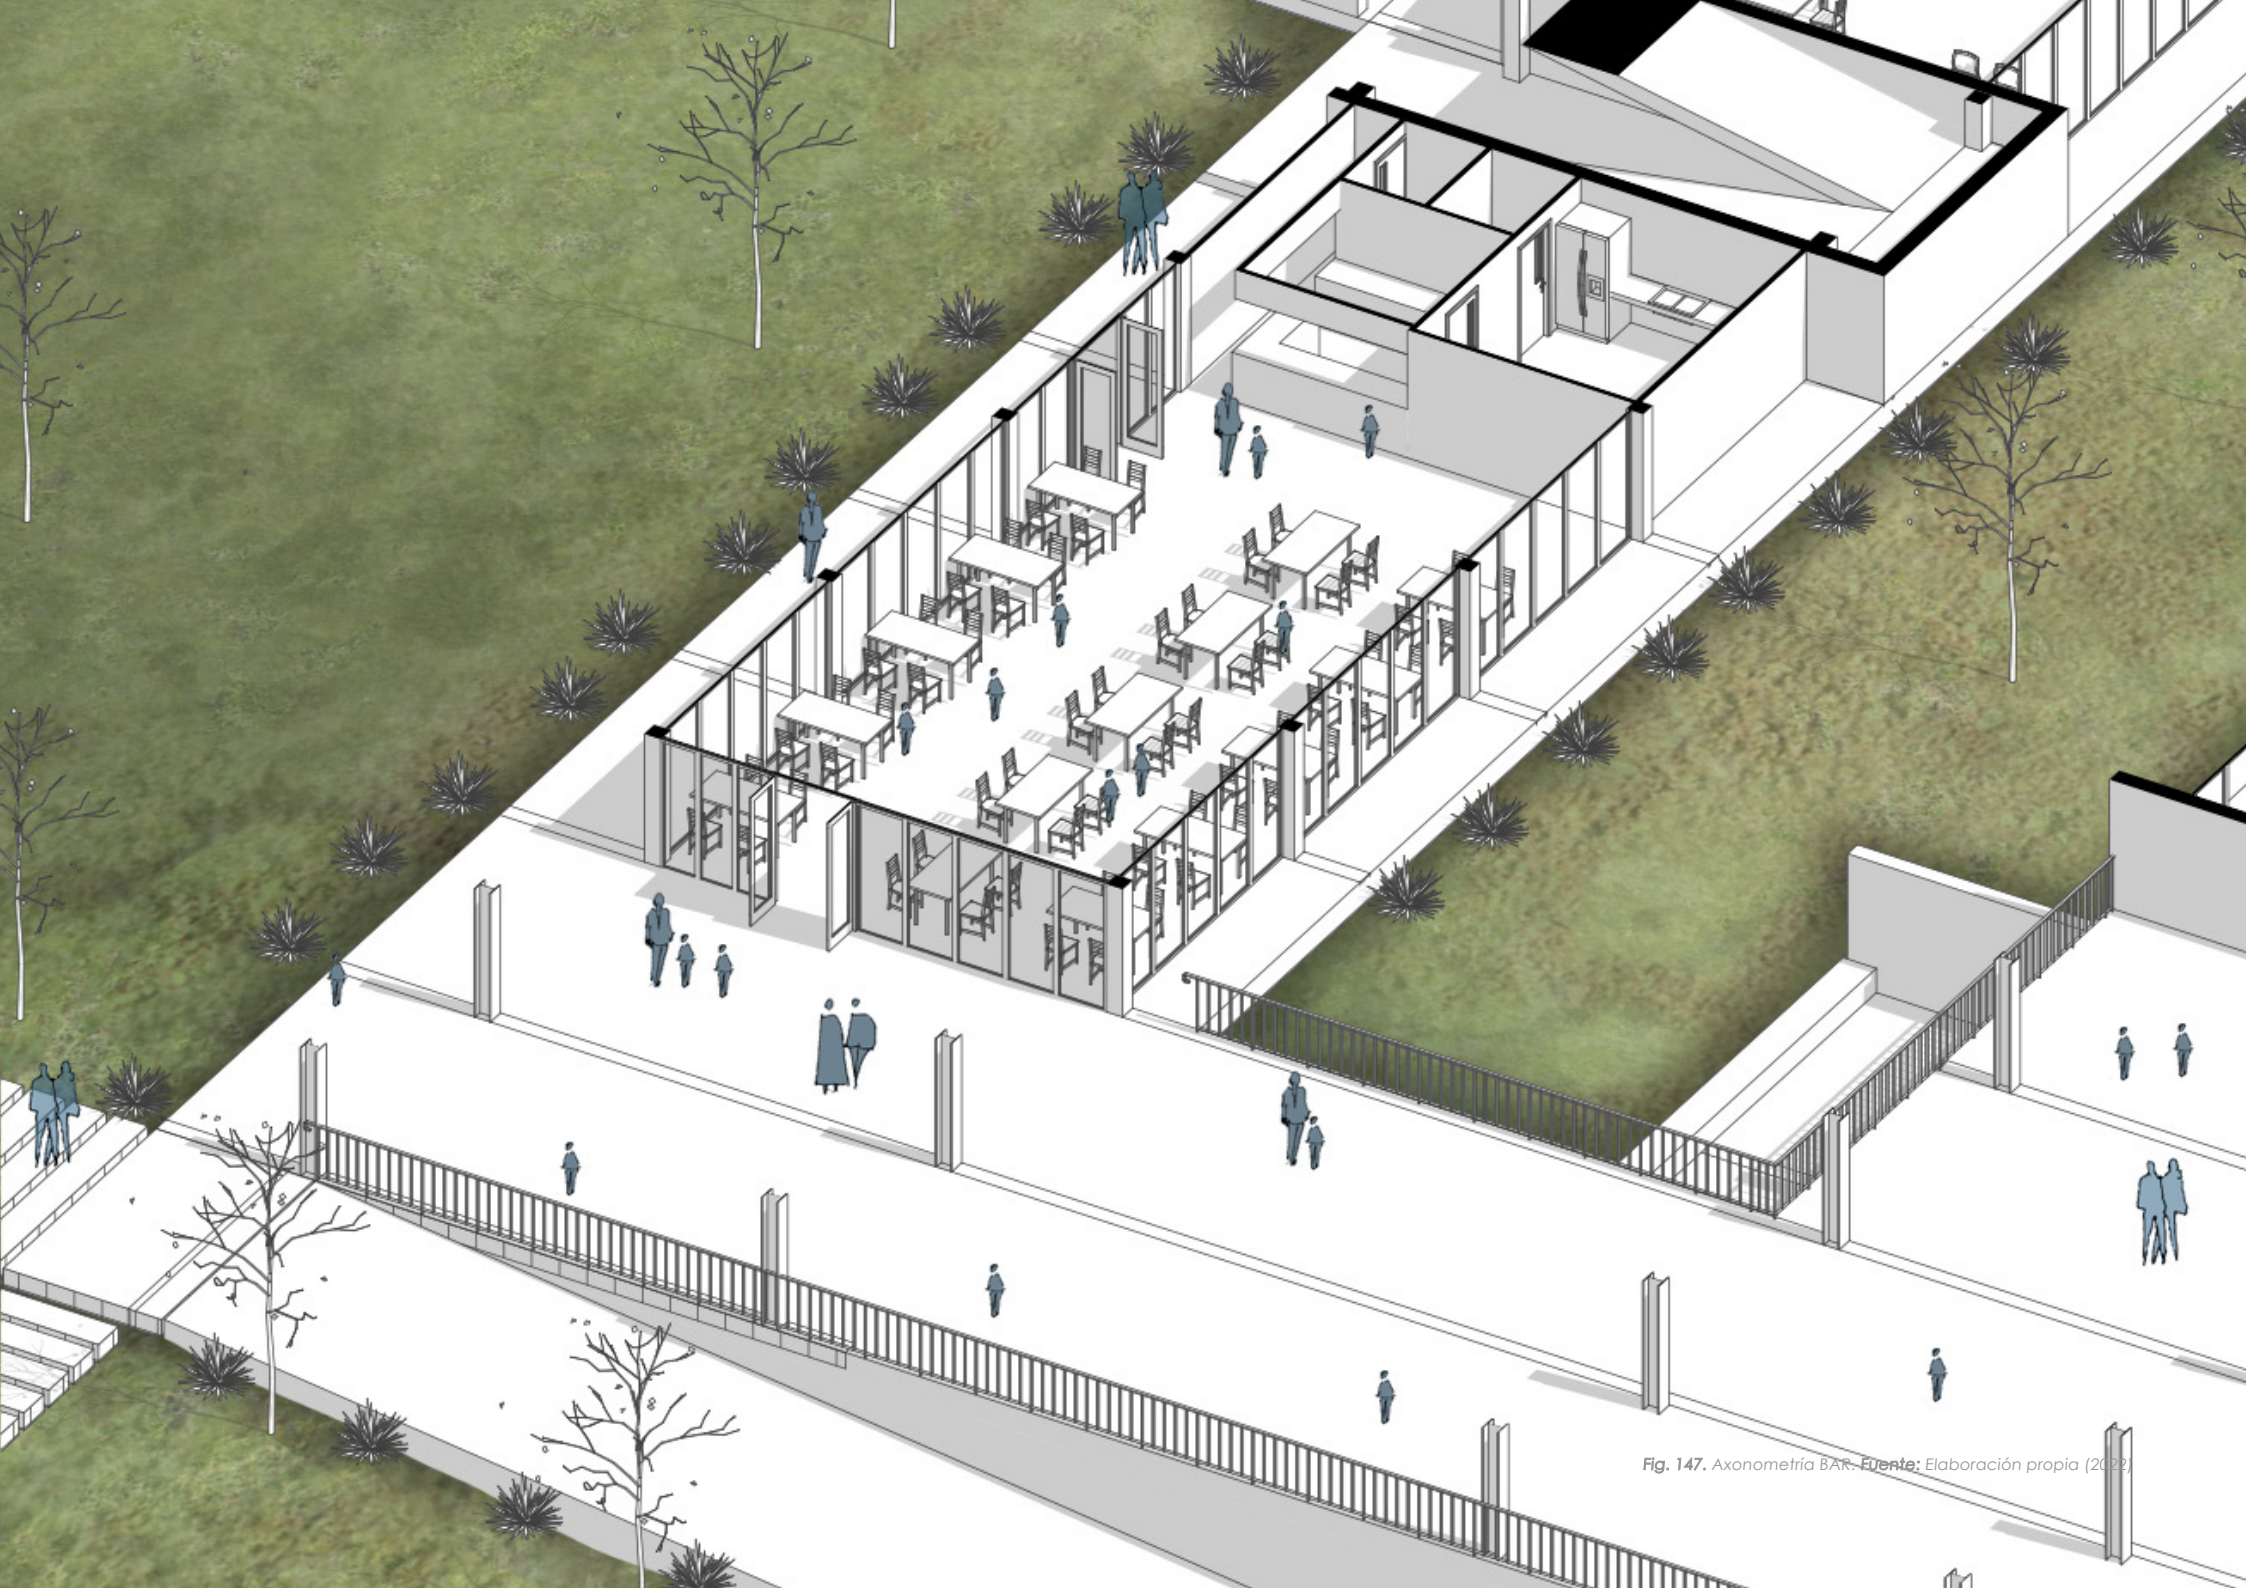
Axonometría BAR. Fuente: Elaboración propia (2022).
